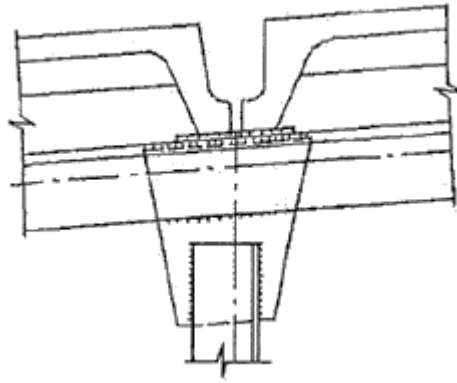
Вузли обпирання на ферму залізобетонних плит
